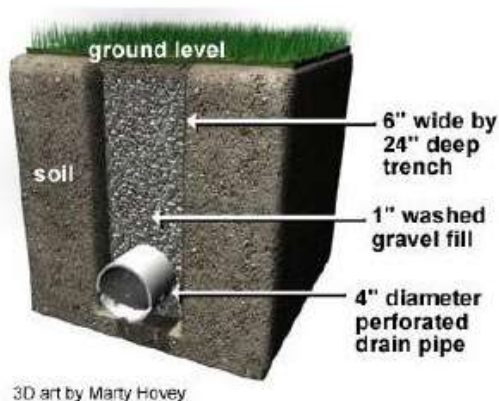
Diseño 3D de sección de un filtro drenante con tubería perforada por Marty Hovey.
